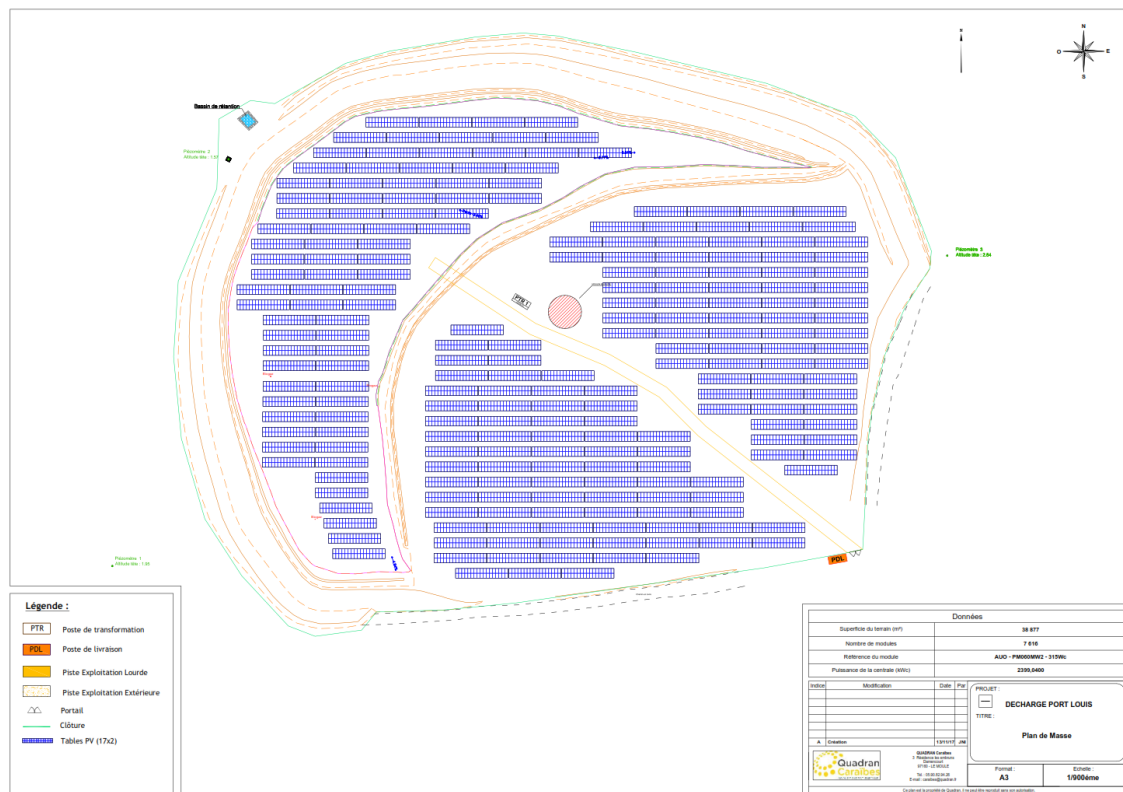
Localisation des 3 zones du projet sur fond de plan de masse
